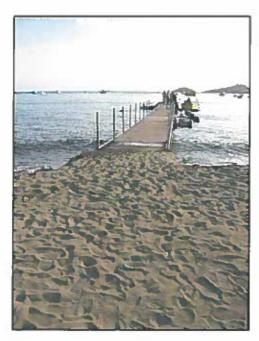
Accès au ponton impossible pour les fauteuils roulants
